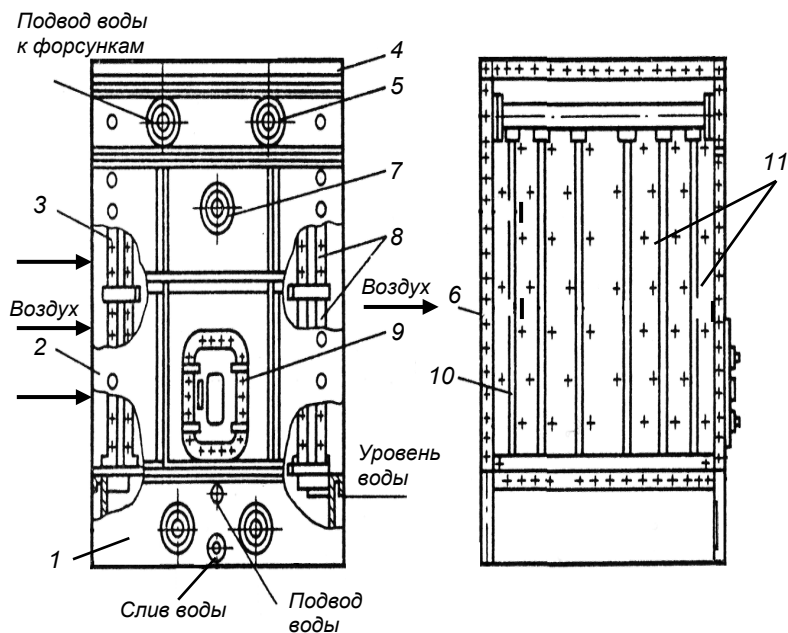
Схема камеры орошения: 1 – бак для воды; 2 – стенка передняя; 3 – воздухораспределитель; 4 – потолок; 5 – коллекторный ряд; 6 – стенка; 7 – светильник герметичный; 8 – каплеуловитель; 9 – дверка герметичная; 10 – стояк; 11 – форсунки
